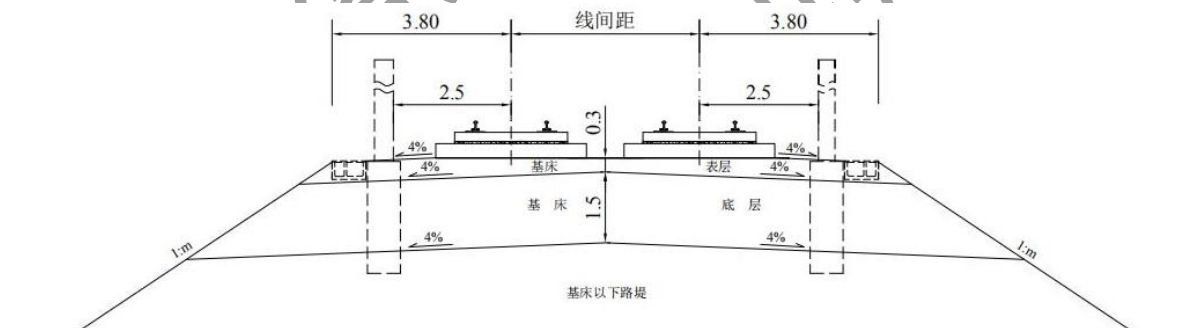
路肩设电缆槽无砟轨道双线路基横断面图 (单位: m)
